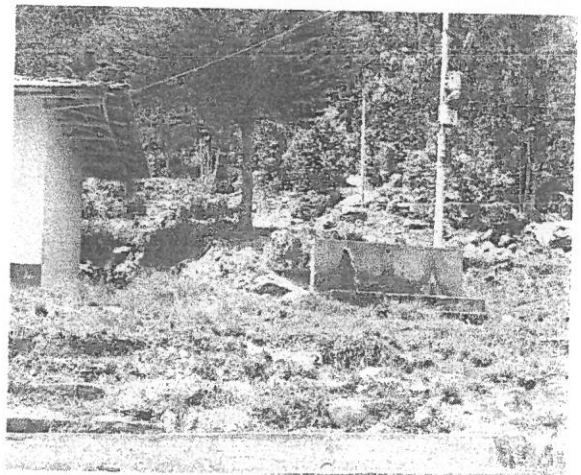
Plataforma deportiva y gradería en mal estado.
